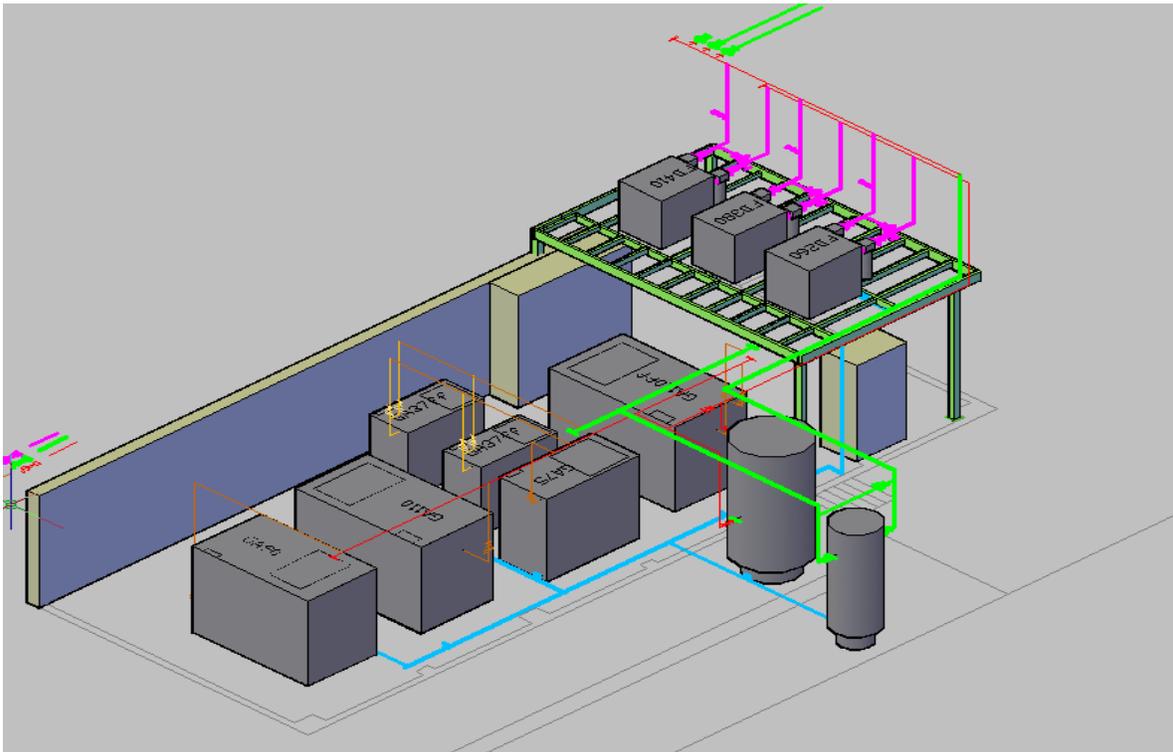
Plano de distribución de equipos y tuberías de un cuarto de compresores.
